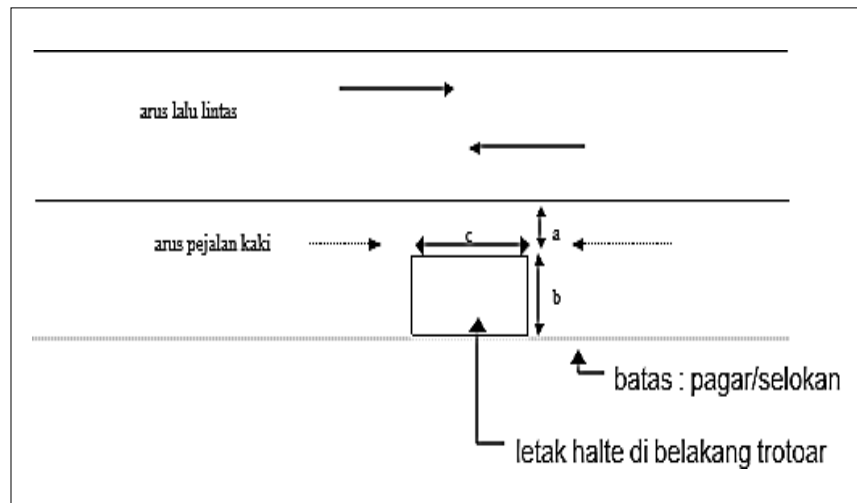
Layout Ukuran Lahan Titik Perencanaan Halte
